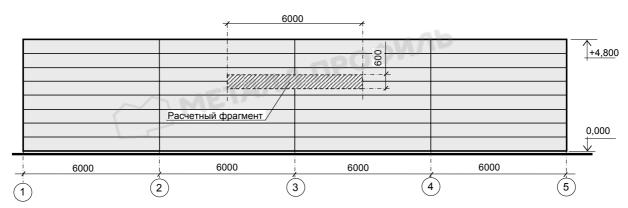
Схематичный фасад проектируемого здания (к примеру Е1)
